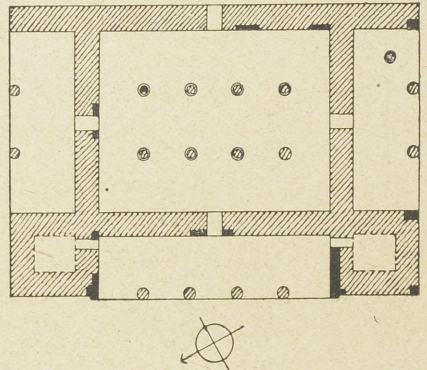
Apadana in Pasargadae, ergänzter Grundriss. Maßstab 1:1000.
